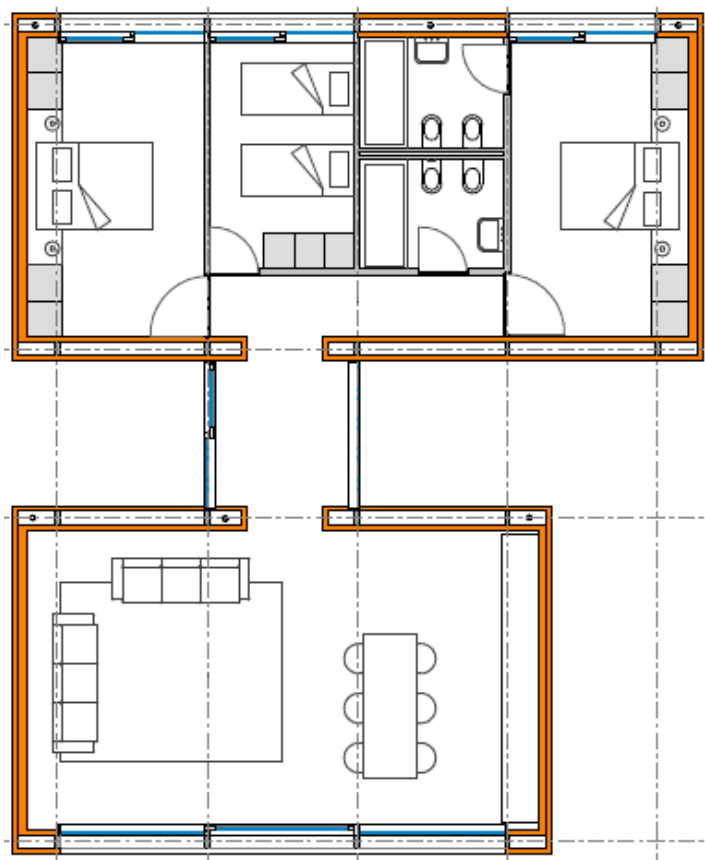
Planta do modelo T3 da MODULAR SYSTEM
